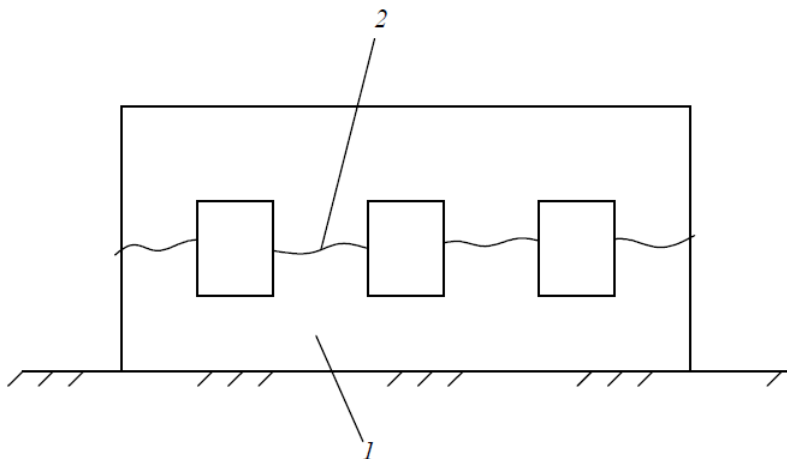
Горизонтальная трещина в стене: 1 – стена; 2 – горизонтальная трещина.
